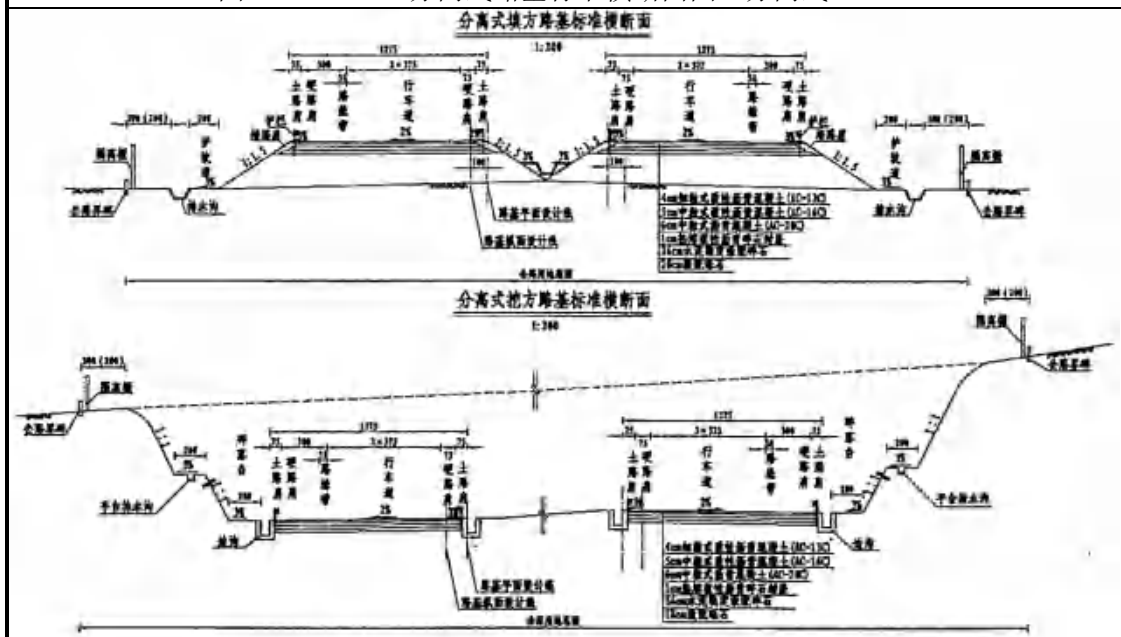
(2) 分离式路基标准横断面图 (分离式 12.75m)
